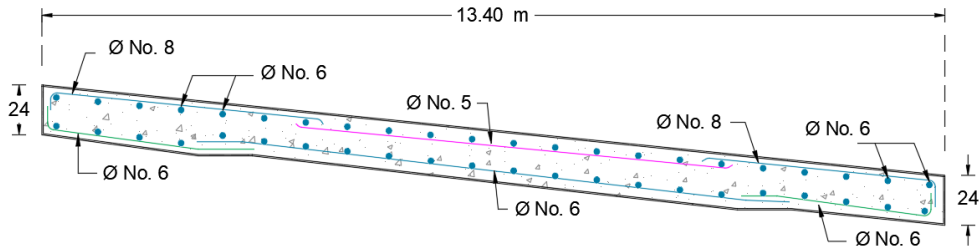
Geometría y refuerzo de losa. Fuente: Elaboración propia
